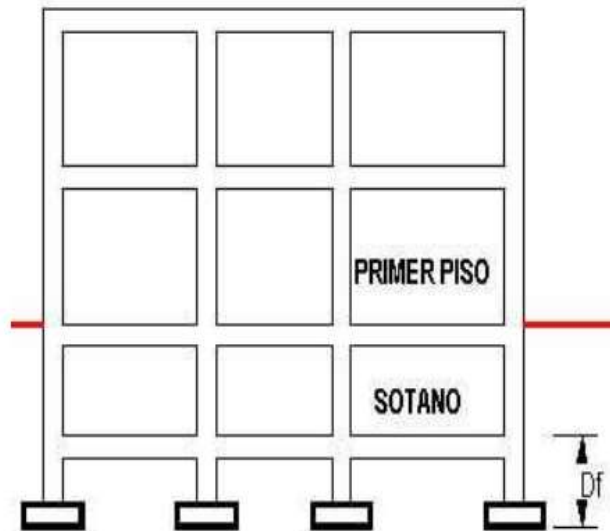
Profundidad de cimentación (D_f) en zapatas bajo sótano.
